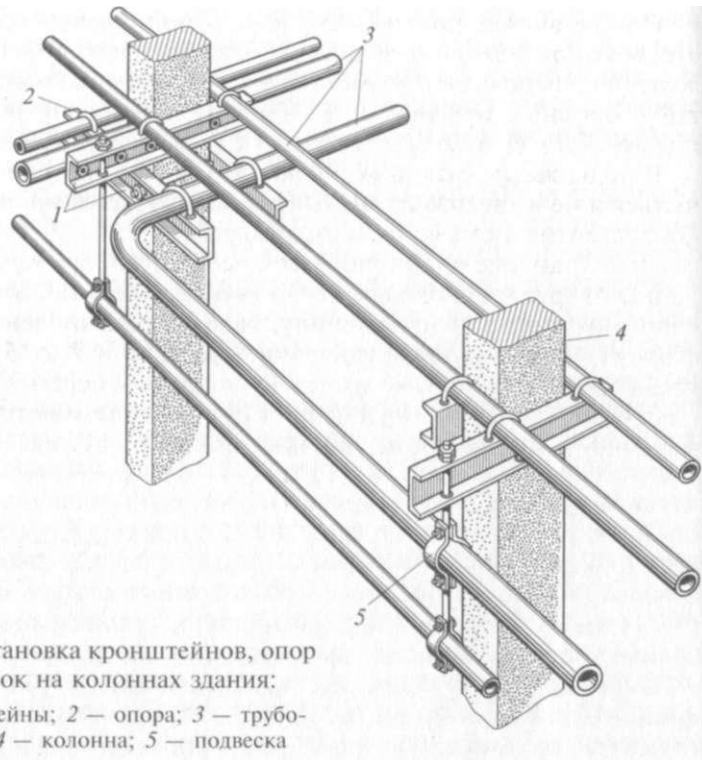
Установка кронштейнов, опор и подвесок на колоннах здания:
